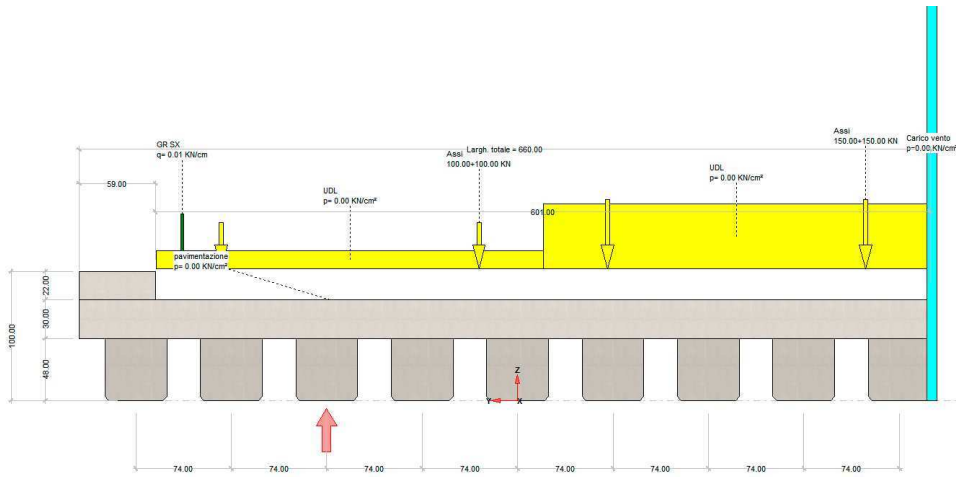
sezione trasversale dell'impalcato, con evidenziata la trave più sollecitata (oggetto di verifica)
